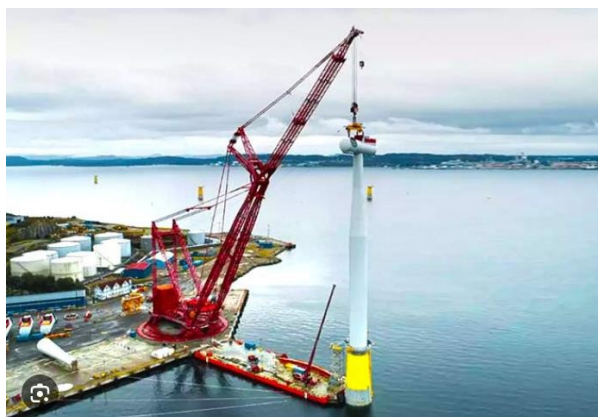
Exemple d'assemblage d'une éolienne.
